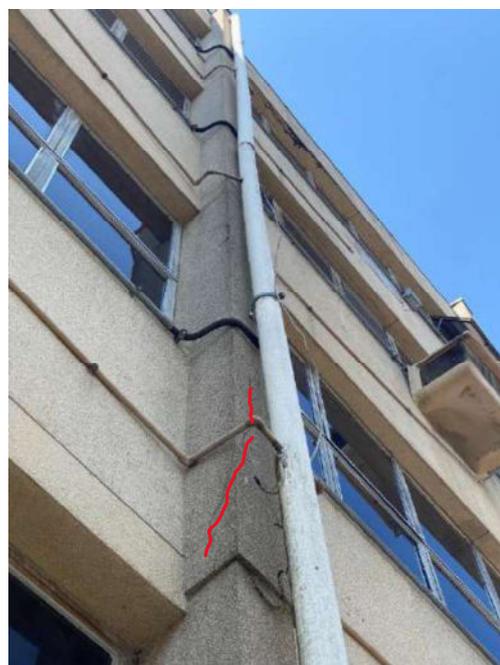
Presença de mofo/bolor e fissura no pilar da fachada exterior
